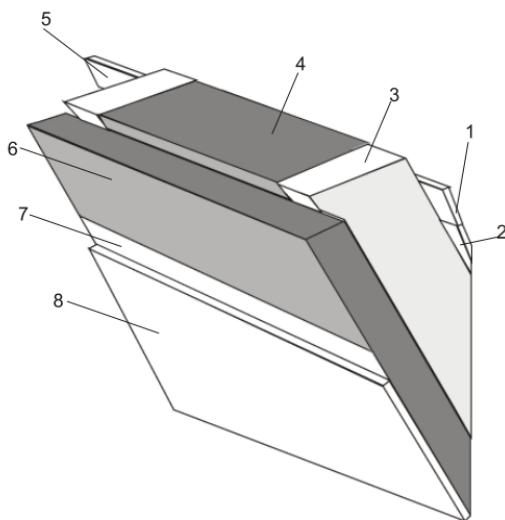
Теплоизоляция скатов крыши под стропилами:
